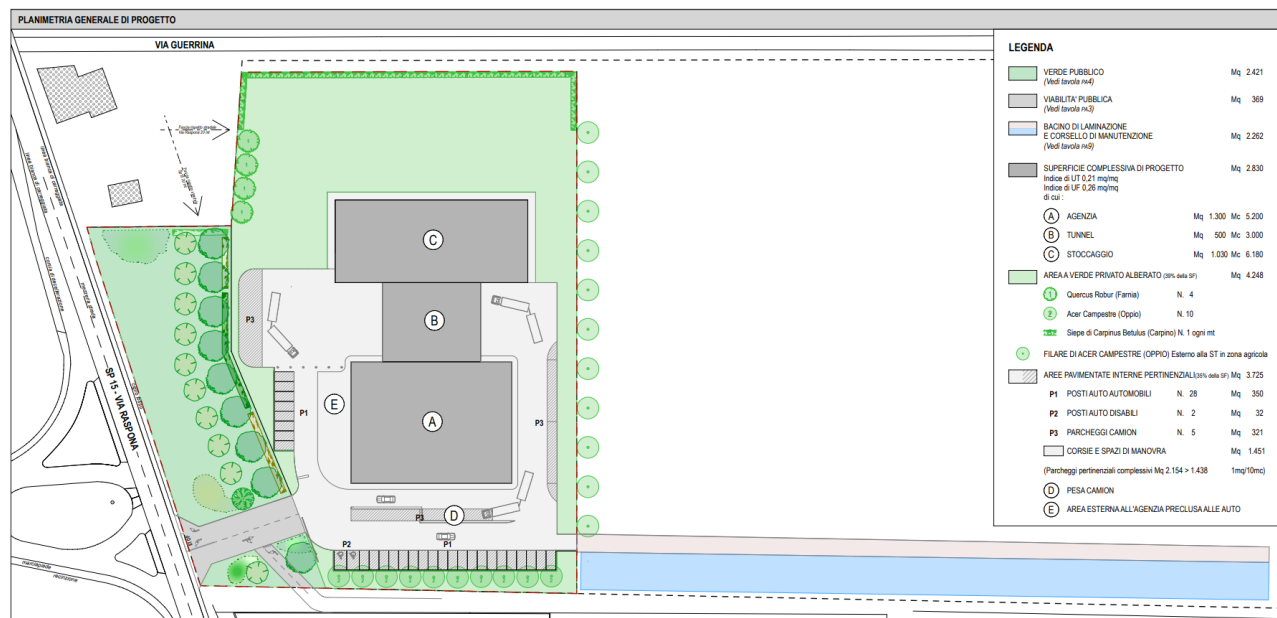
Vista planimetrica del progetto del nuovo stabilimento.
